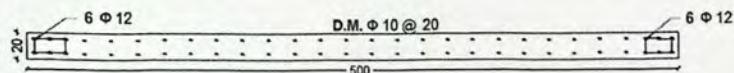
Sección transversal Muros 1 y 2, Edificio A
